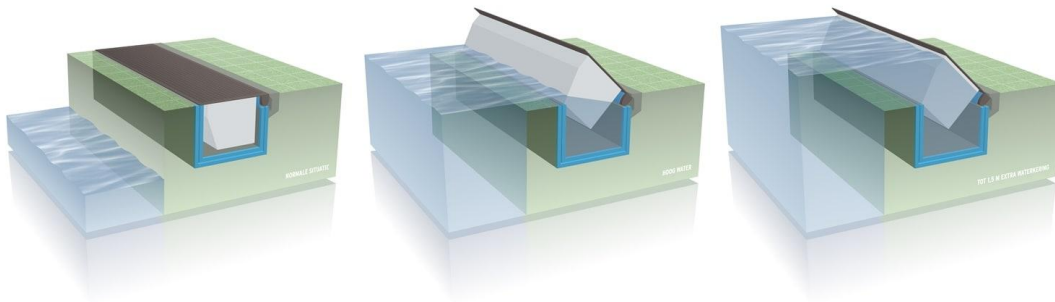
Impressie demontabele kering die op locatie opgeslagen ligt - Dutchdam Cento.
